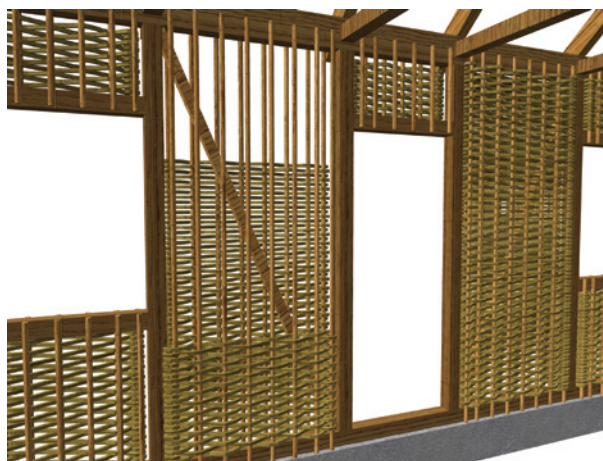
Model budynku w konstrukcji strychulcowej – trzeci etap konstrukcji; źródło: rys. autorki
